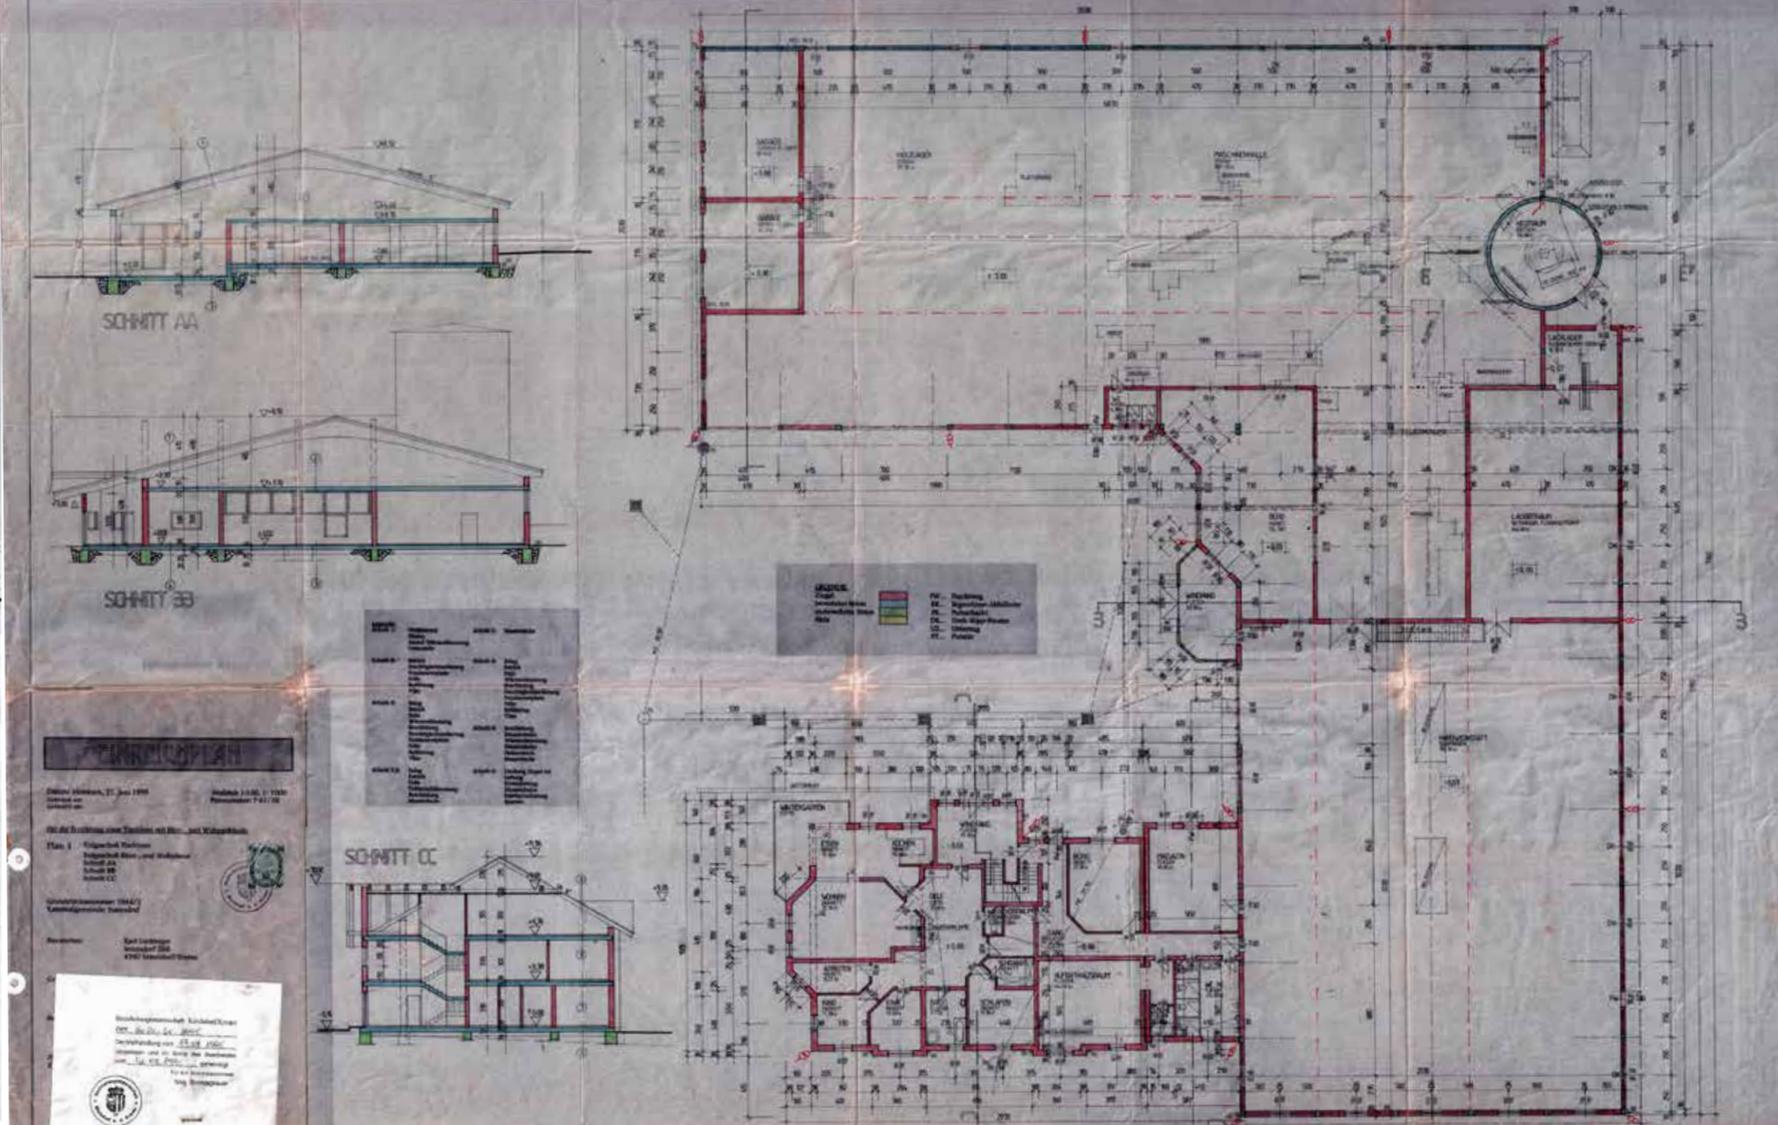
behördlicher Einreichplan 1995 - Schnitte A-A, B-B, C-C, Grundriss Erdgeschoß
